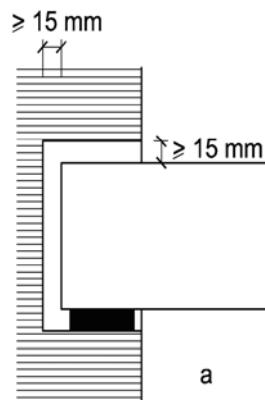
Apoyo actual de viga en muro. Present beam bearing on wall. Fig. 19. Detalle de CTE-DE-SE. Detail from the Spanish Technical Building Code. Fig. 20. Detalle/Details: 1. Muro de mampostería de sillarejo. Rubble stone wall made with rough-hewn ashlar; 2. Viga recuperada de madera de castaño. Recovered chestnut beam; 3. Apoyo en material elastómero. Elastomer bearing; 4. Viguela de madera de castaño. Chestnut joist; 5. Zoquete. Inter-beam block; 6. Tarima de madera de castaño. Chestnut floor 7. Rodapié de madera de castaño h=20cm. Chestnut baseboard h= 20 cm; 8. Revoco de mortero de cal. Lime mortar rendering.
